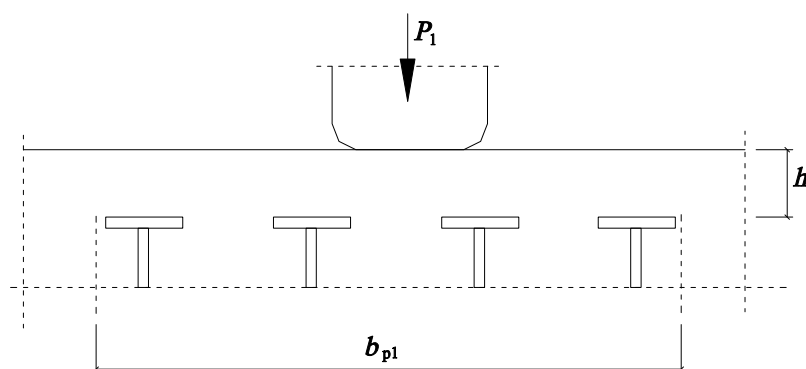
Распределение нагрузки от автомобильного колеса на стальные балки настила [11]
